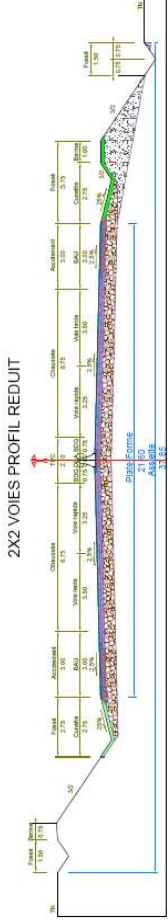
Profil en travers type de la voirie projetée – 2x2 voies en profil réduit
